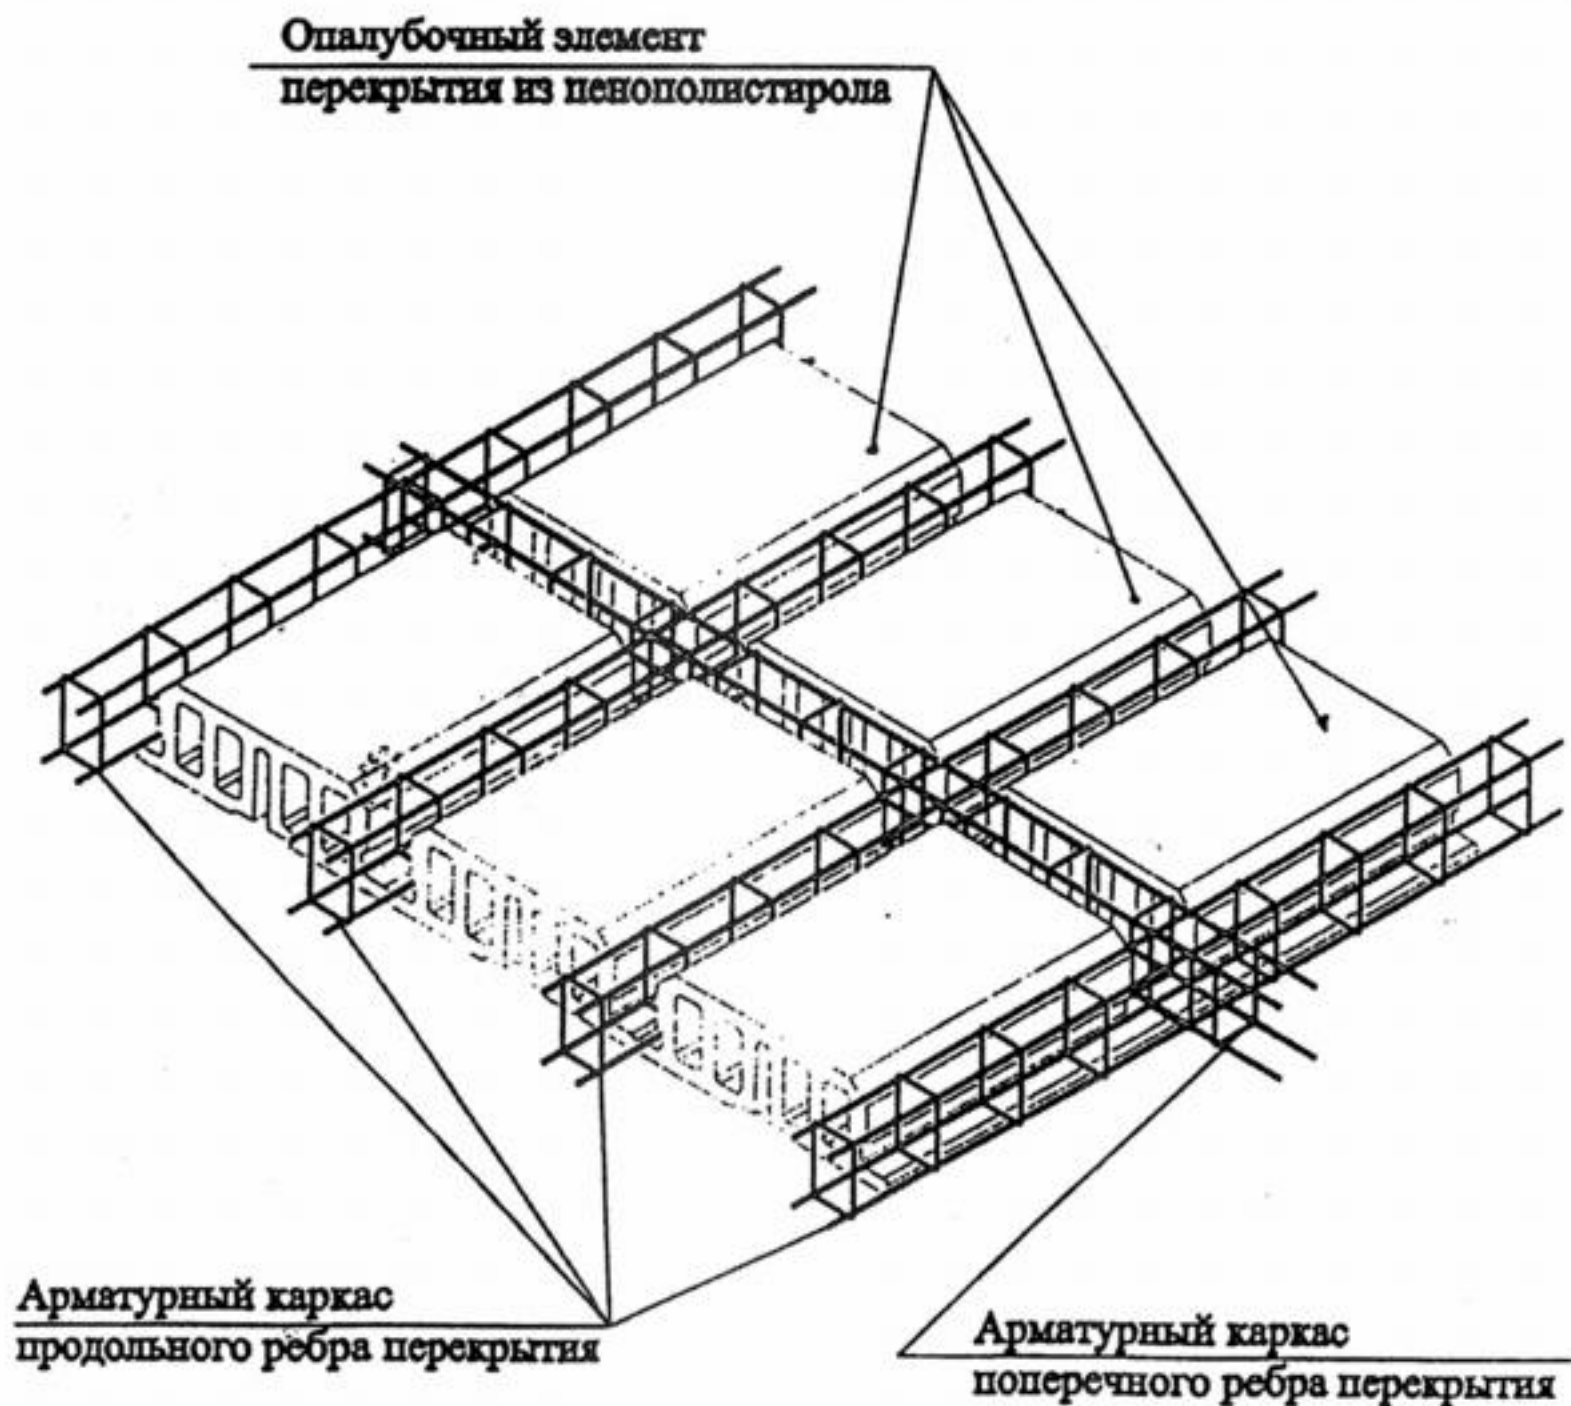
а - Элемент опалубочный перекрытия шириной 600 мм.
